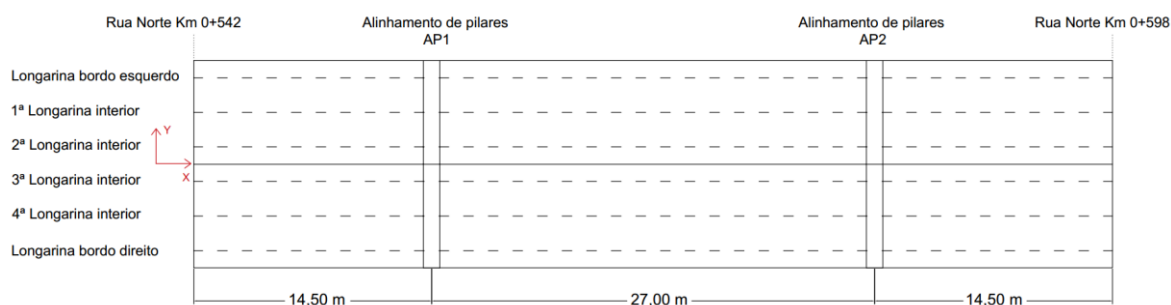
Planta geral da ponte, de acordo com a solução estrutural proposta.
